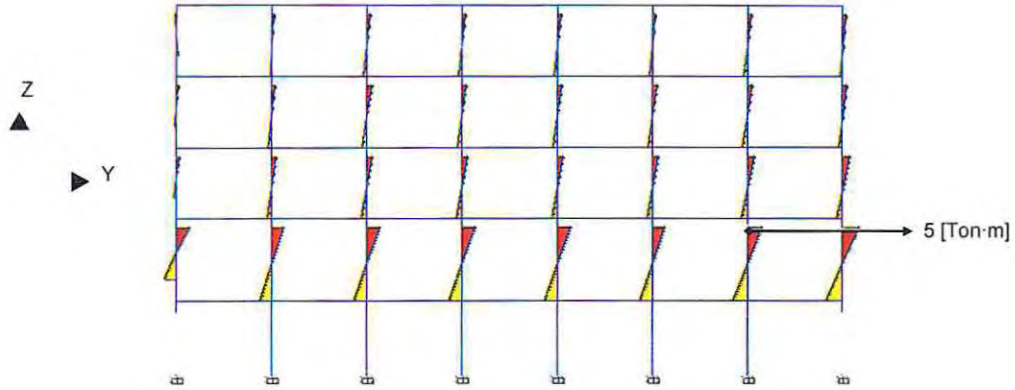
Diagrama de momento en columnas interiores, eje B, estructura aislada.
